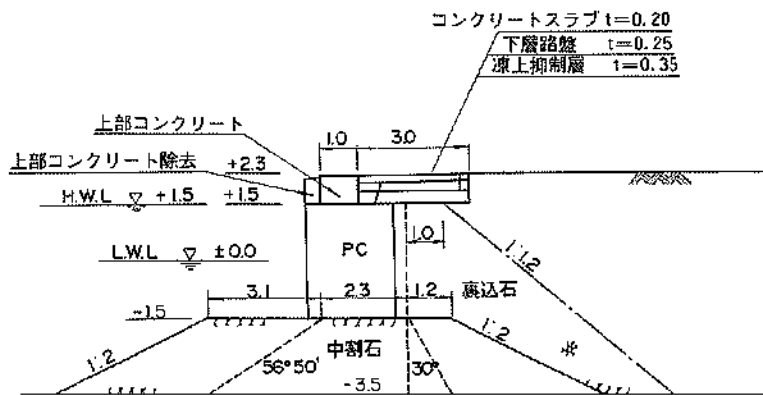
厚岸漁港 (海南地区) ⑩-2.5m物揚場被災状況断面図
